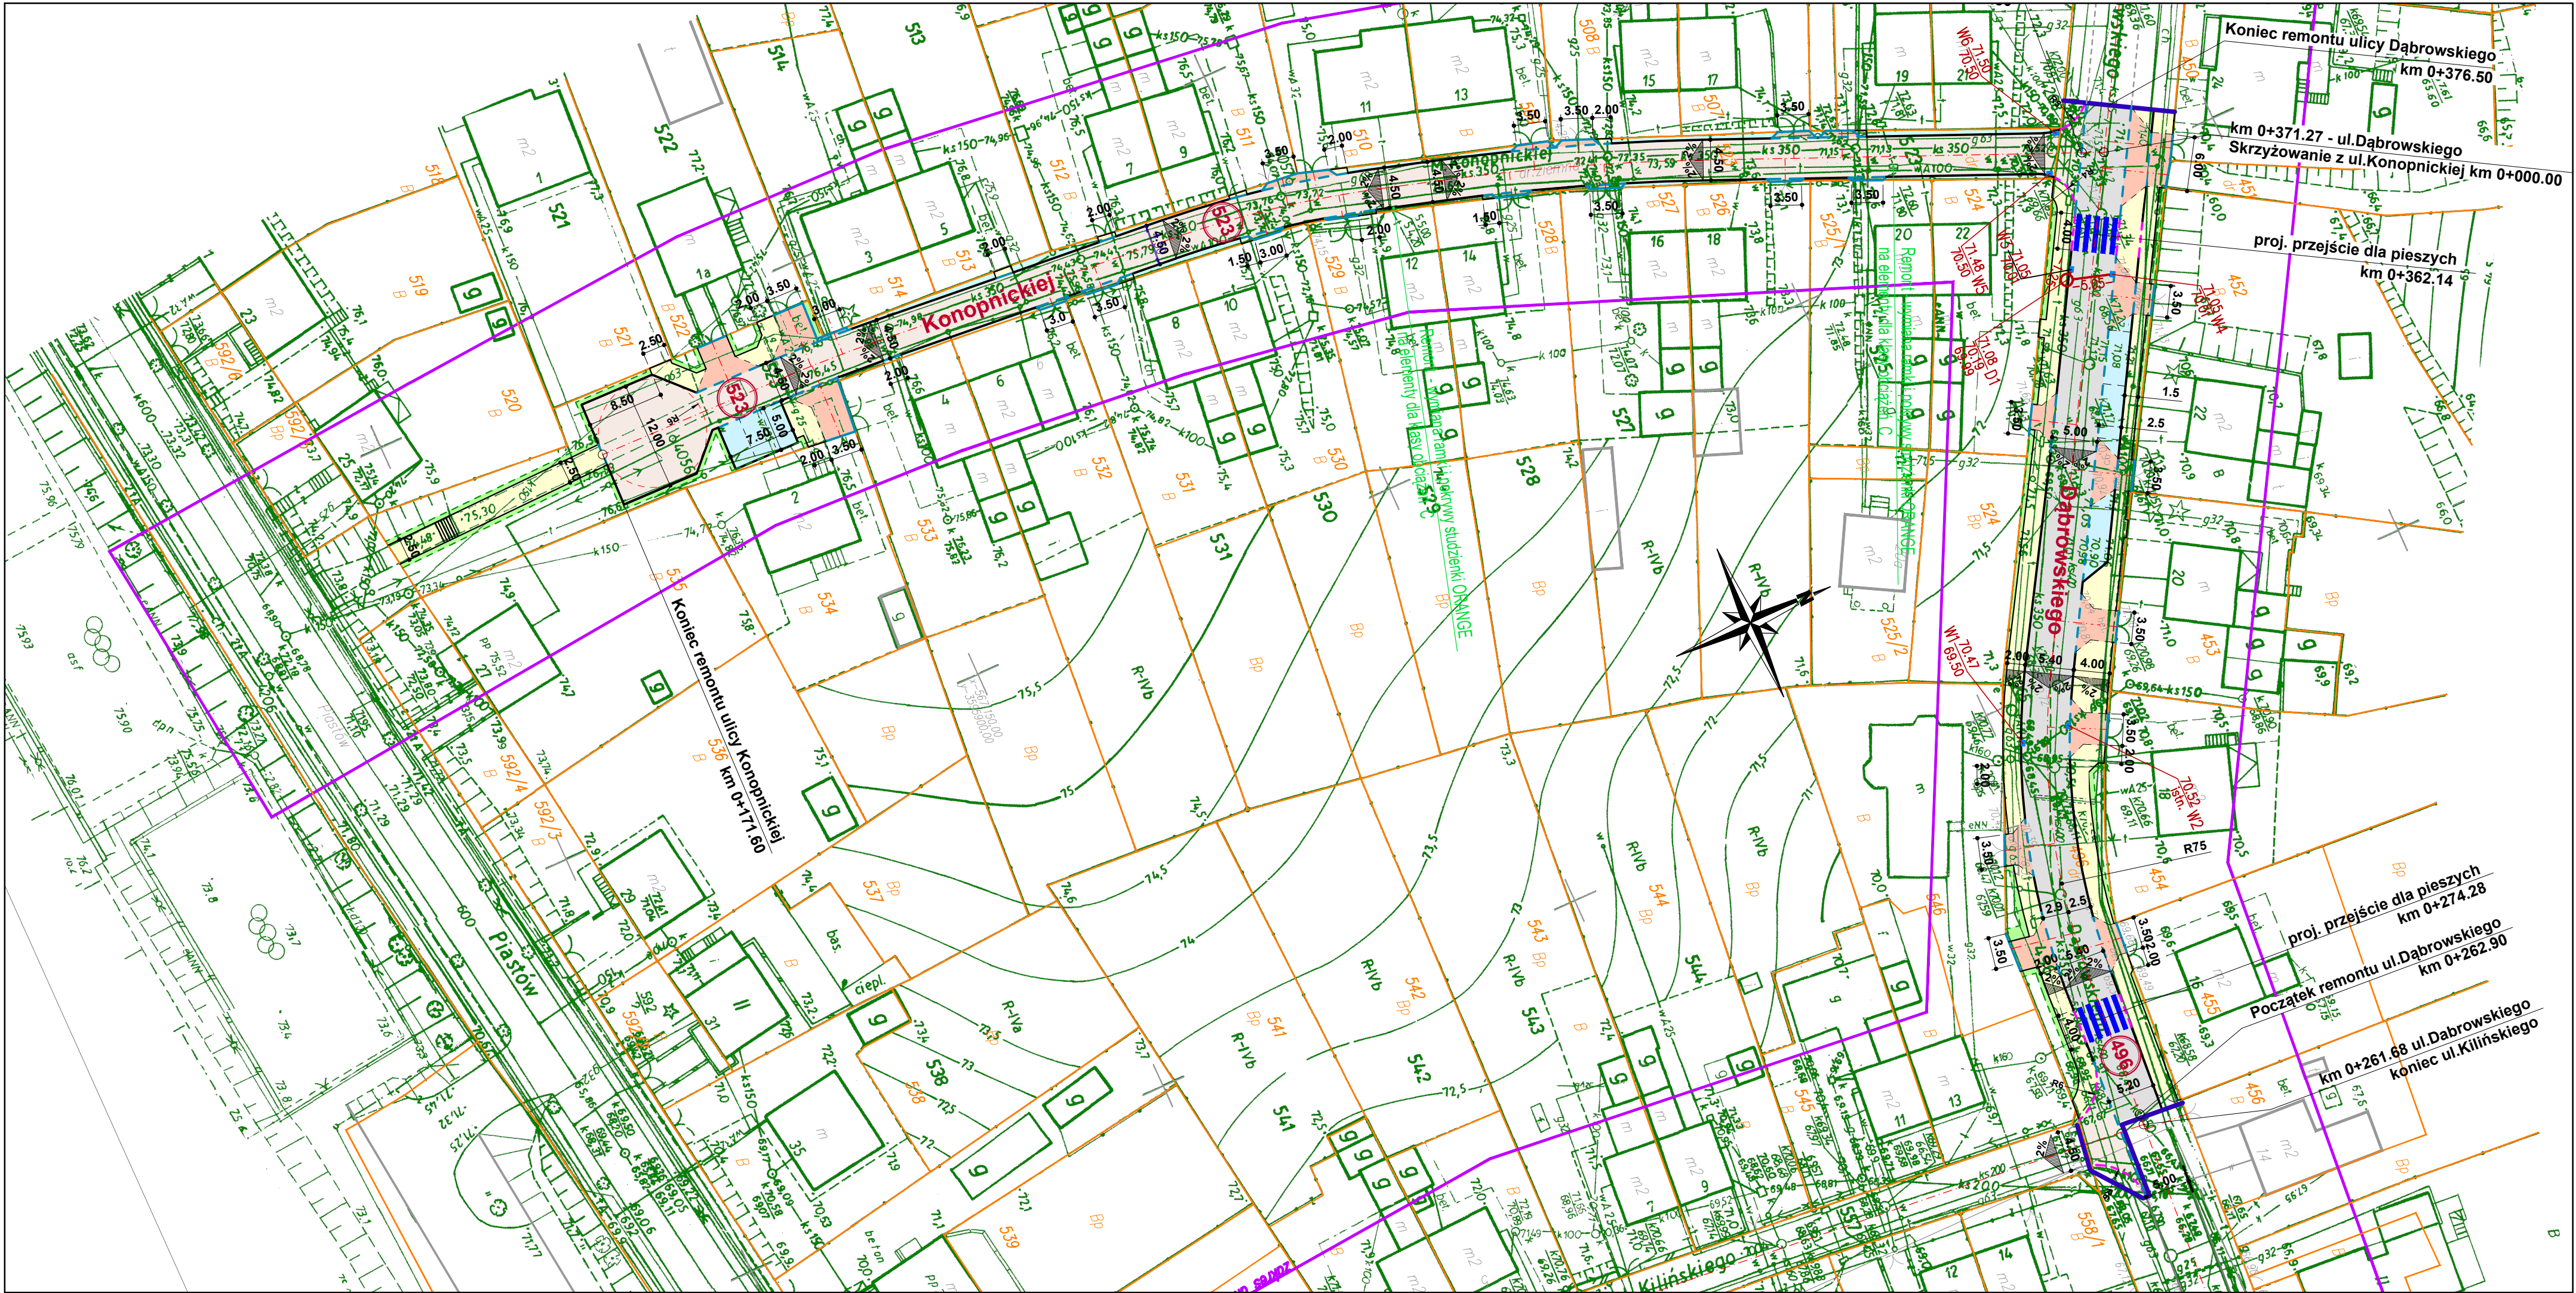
Plan Orientacyjny	str. 12
